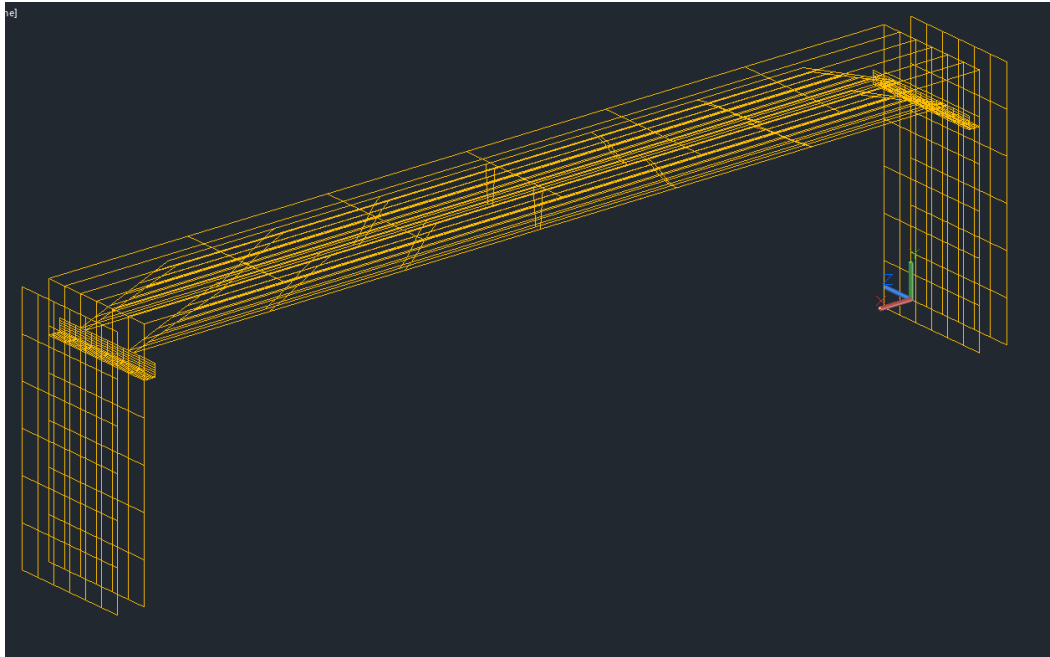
Modelamiento por división de caras en AutoCAD Civil3D
